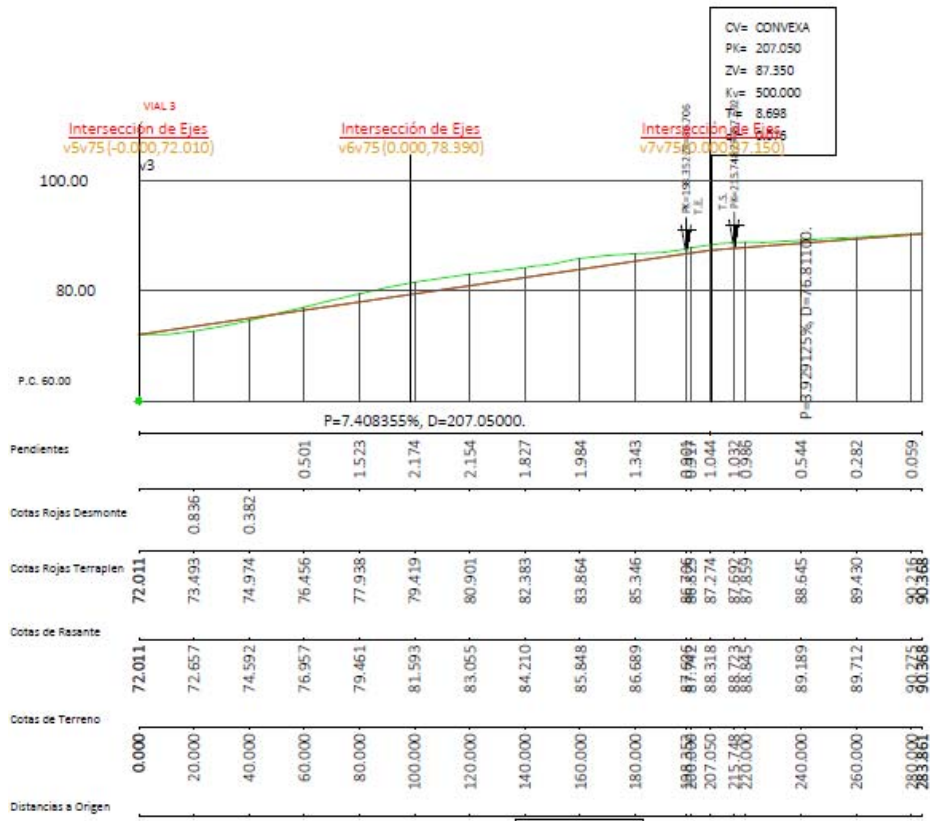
Imagen de la sección longitudinal del vial 3 en la alternativa 1.
